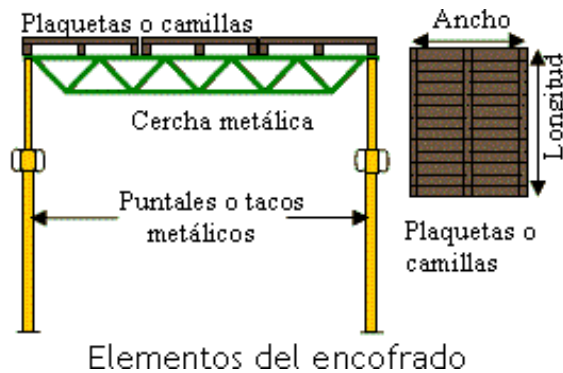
Elementos del Encofrado. Fuente: [www.bagant.com](http://www.bagant.com)
